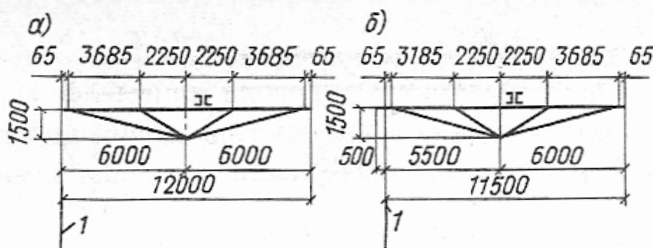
Схемы решетчатых прогонов: а – рядовой; б – крайний (у торцов и ТДШ); l – ось стропильной фермы
